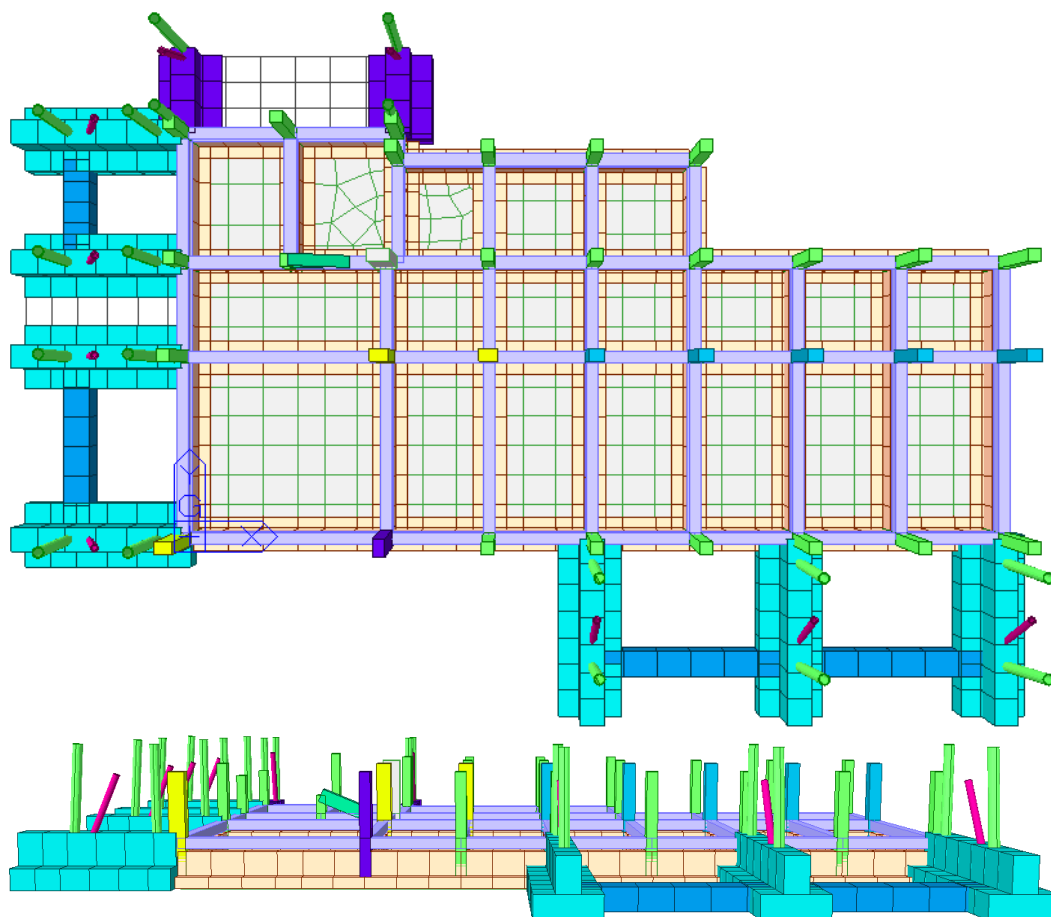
INSERIMENTO SISTEMA DI FONDAZIONE NEL MODELLO FEM DEL BLOCCO A: VISTE IN PIANTA (PIANO XY) E FRONTALE (PIANO YZ)
